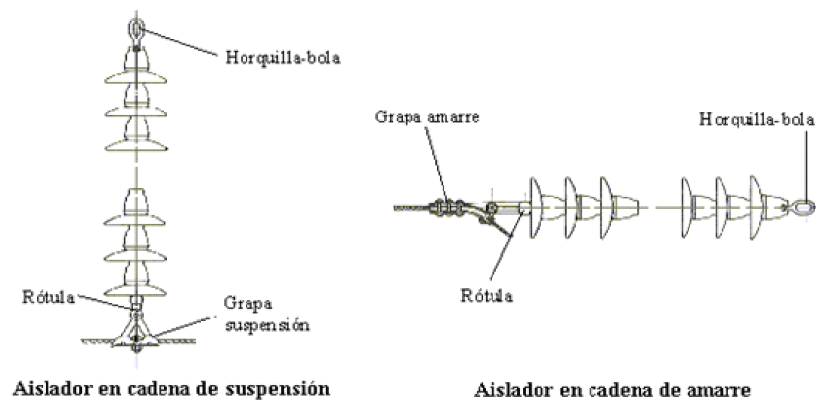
Disposición de aisladores tipo caperuza en cadenas de amarre y suspensión.
